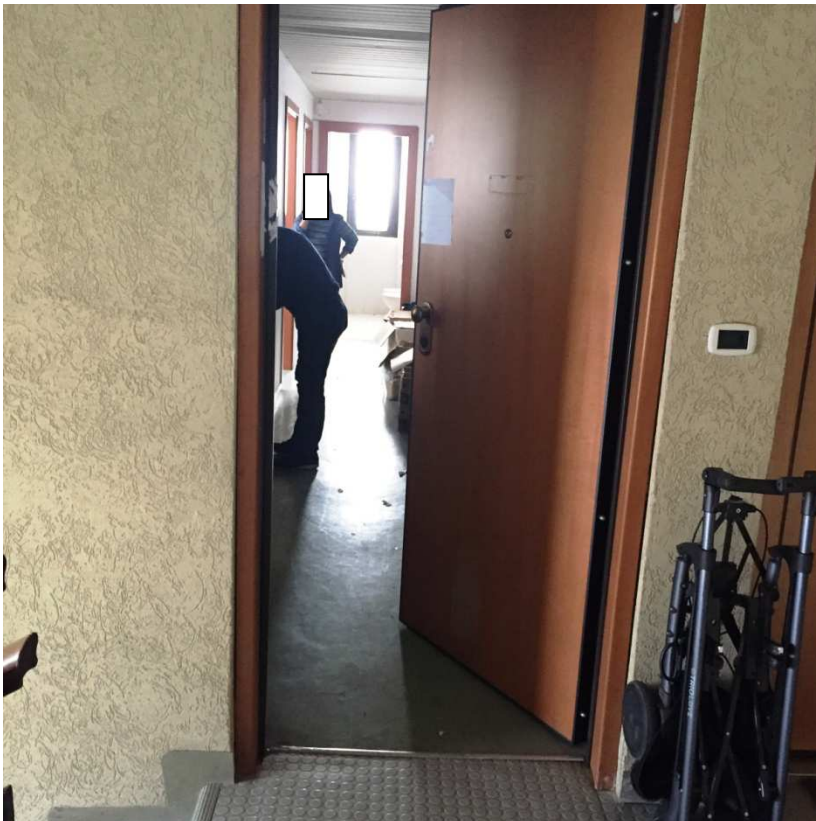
Vista dal pianerottolo del portoncino di ingresso e del corridoio
